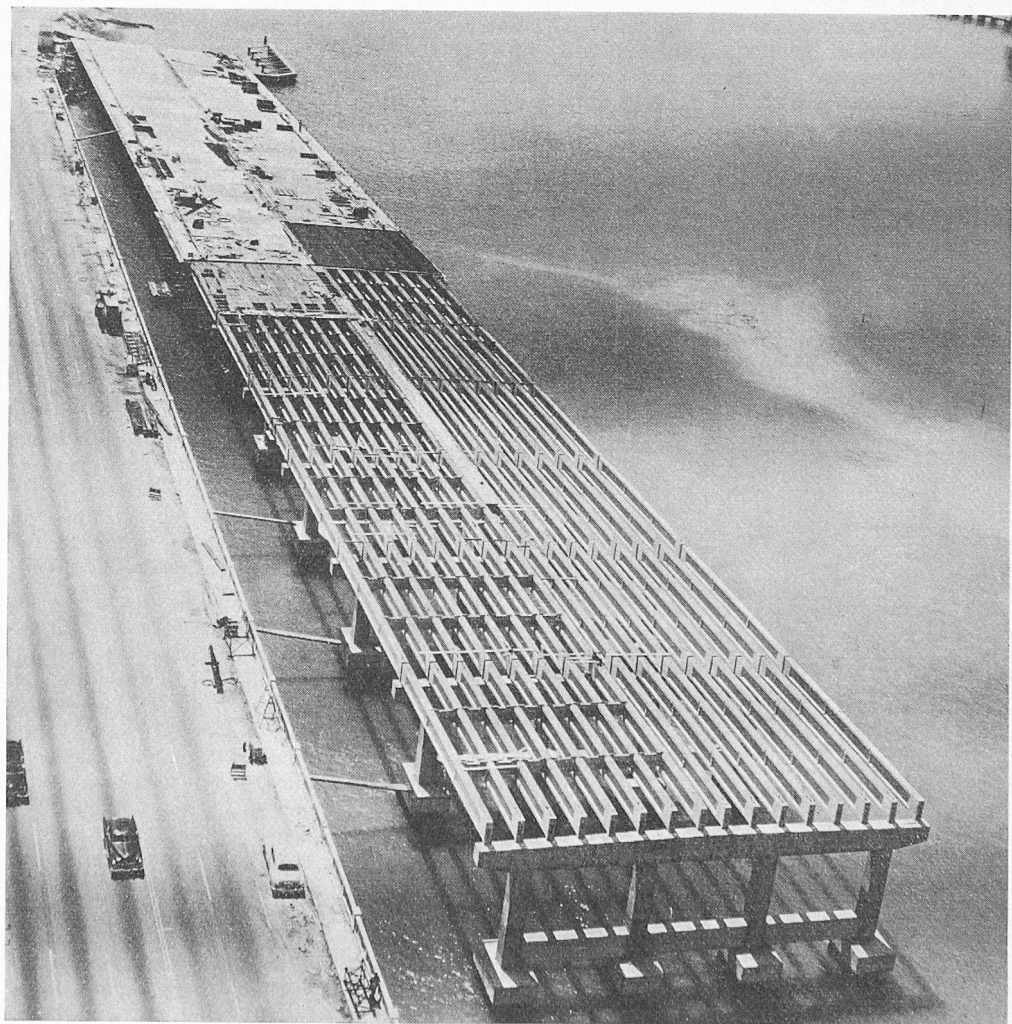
Mac Arthur Causeway Brücke in Florida. Pfähle in pretensioned concrete. Brückenträger kombiniert pretensioned und posttensioned. Beton mit Pozzolithzuschlägen. Photo The Master Builders Co., Cleveland, Ohio
